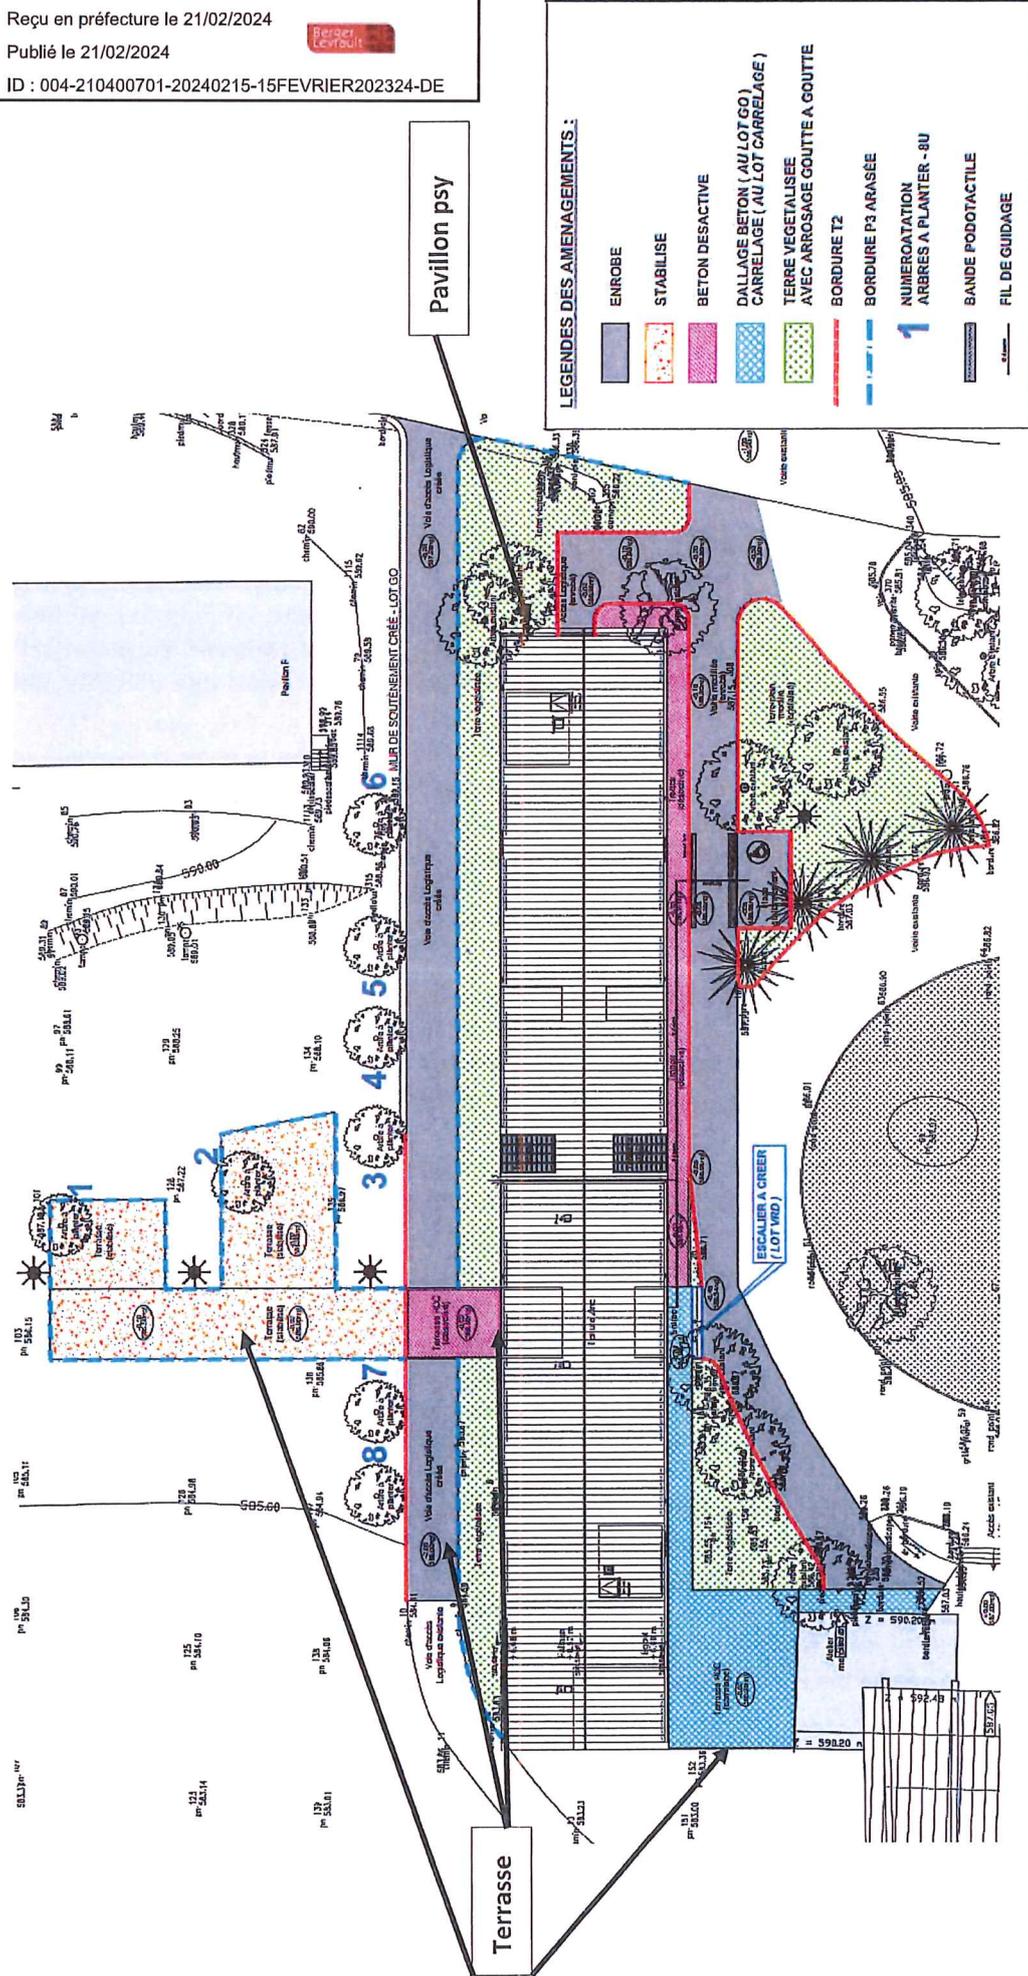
Plan de masse du projet (source : Atelier 3a, 2022)
